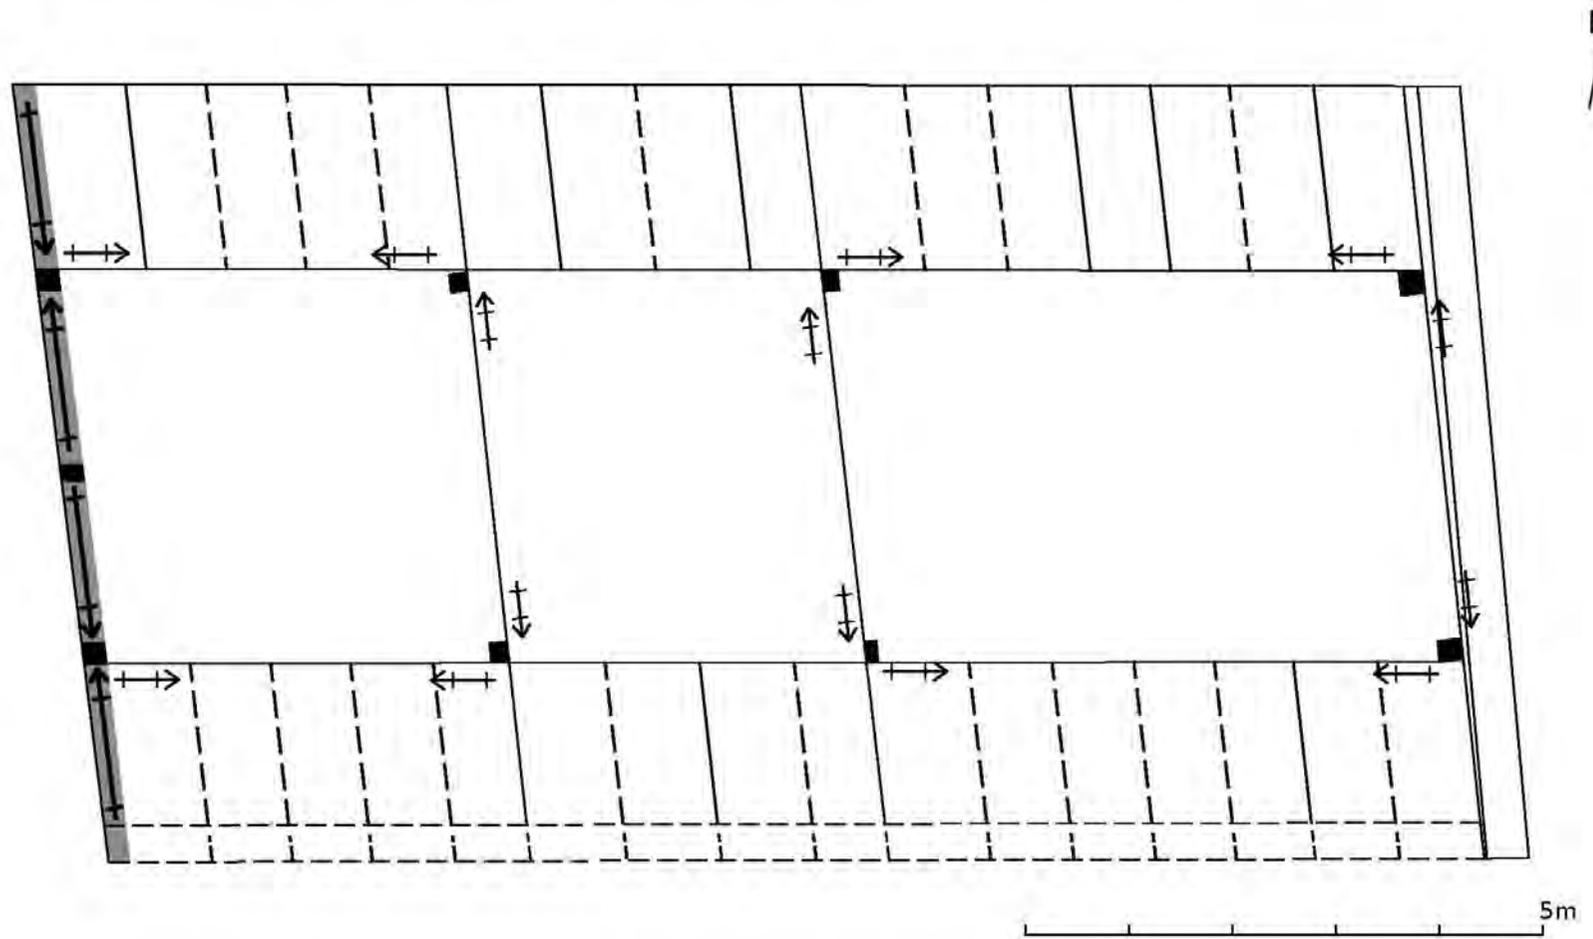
Freiburg, Markgrafenstraße 16a, sog. Melanchthonscheune, Systemgrundriss 1. Dachgeschoss
